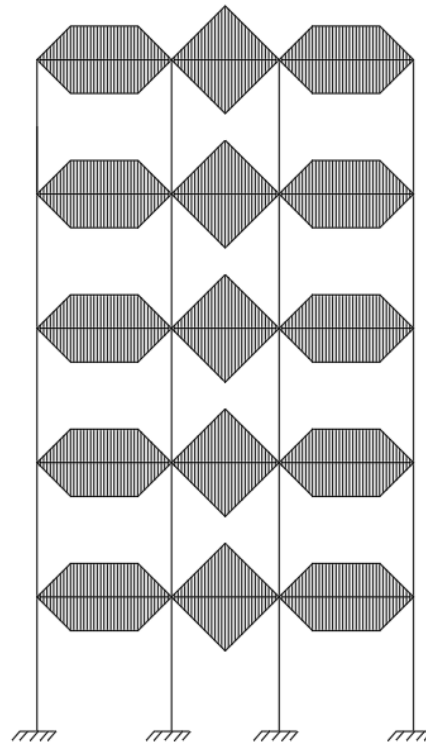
Denah Potongan Portal As C dan Portal As 3 Lantai 3
